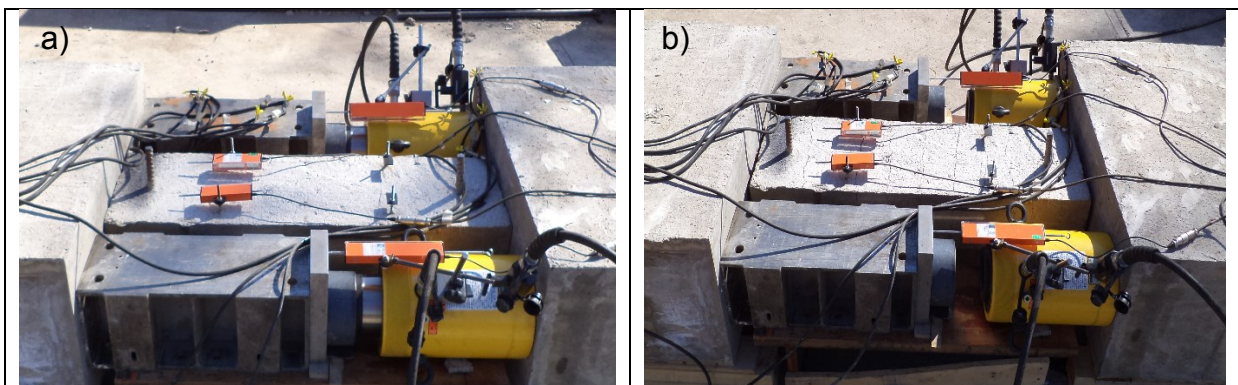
a) Comienzo ensayo a tracción, b) Término de ensayo a tracción, se observan grietas.
